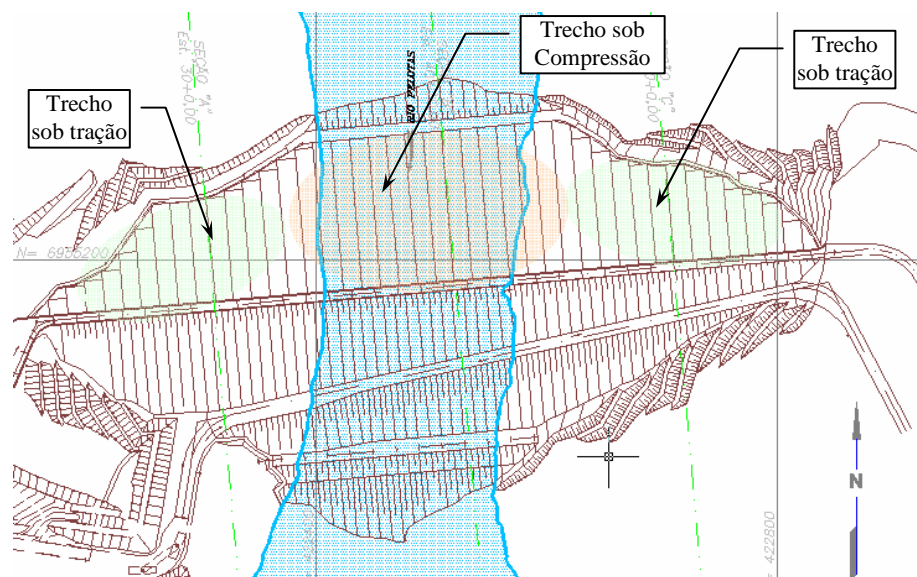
Mostrando um pano da laje e a separação da armadura simples e dupla.
